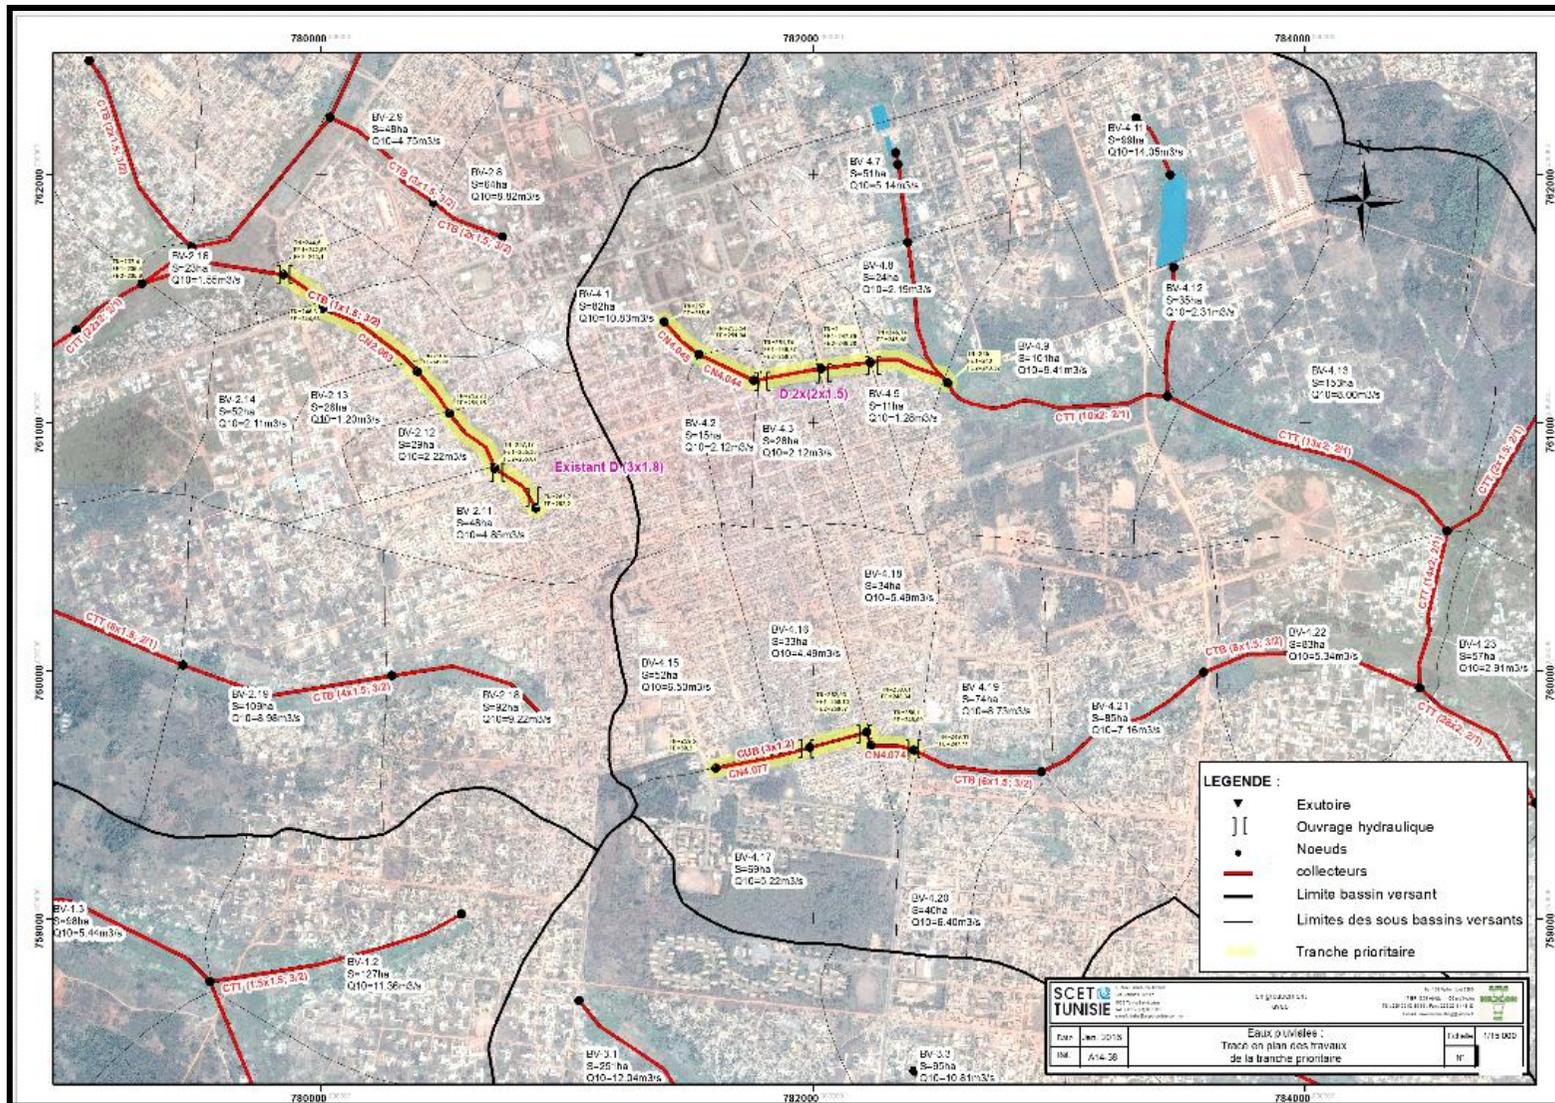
Eaux pluviales, tracé en plan des travaux de la tranche prioritaire
